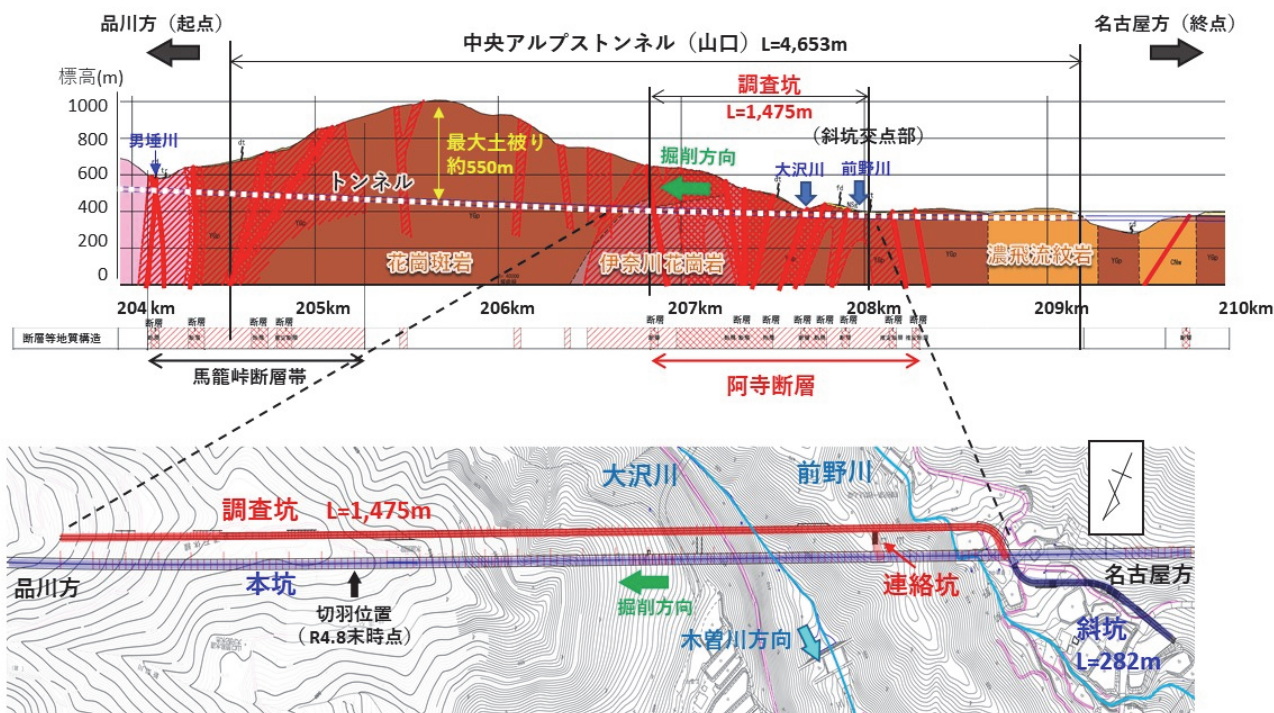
地質縦断図（上）及び調査坑周辺の平面図（下）
